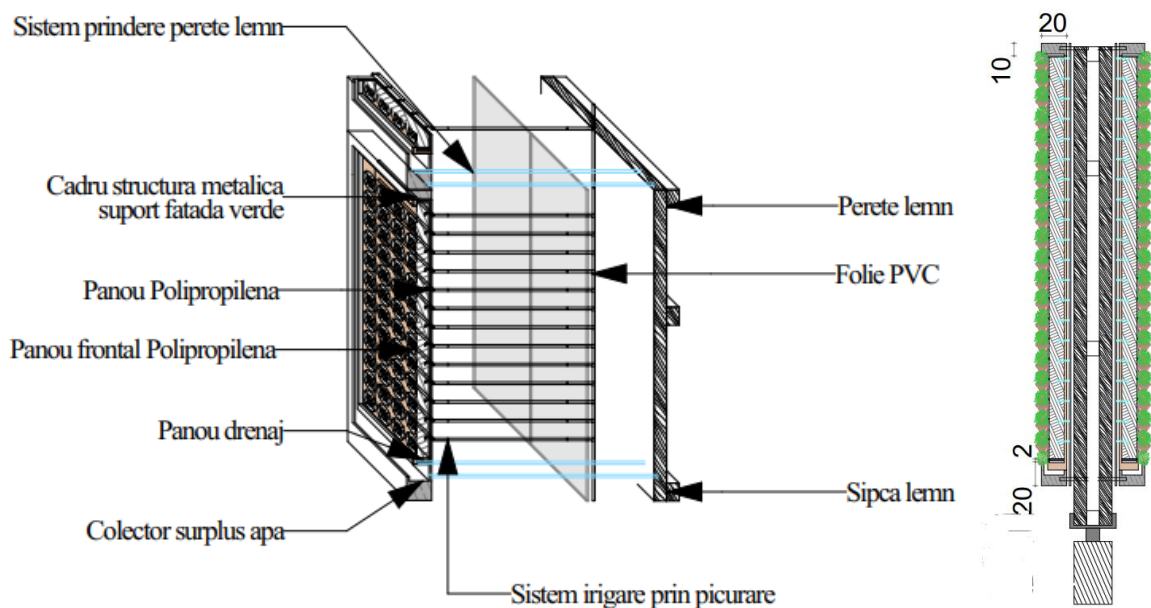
Sistem perete verde pentru plante suculente, varianta de sedul și iarba
